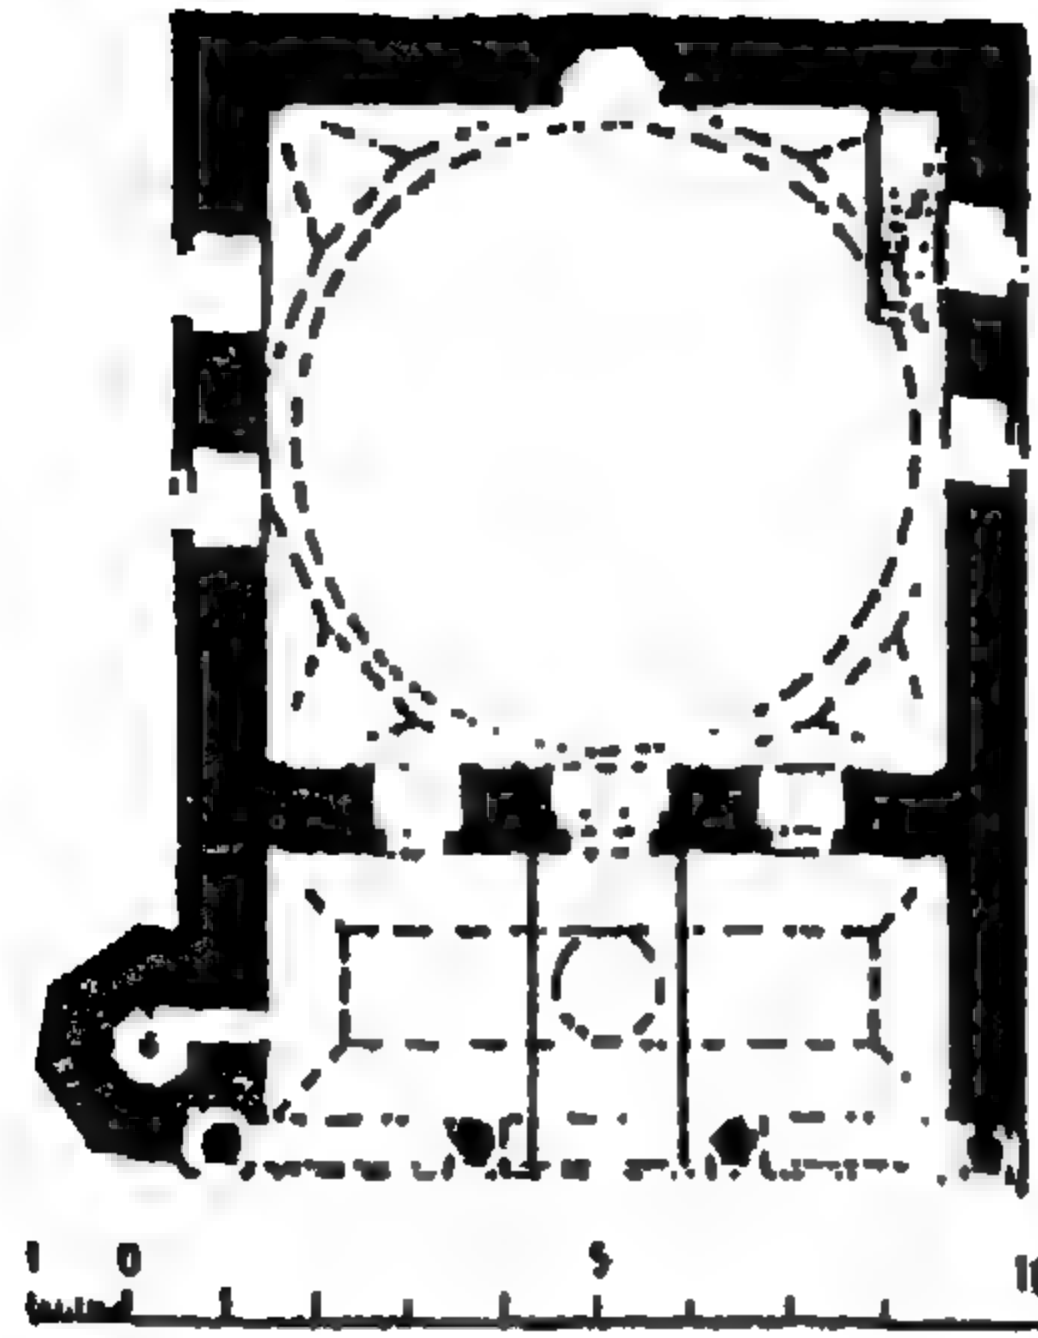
مسقط أفقي لمسجد قبة دادية بمدينة دمار (عن د. ربيع خليفة)
